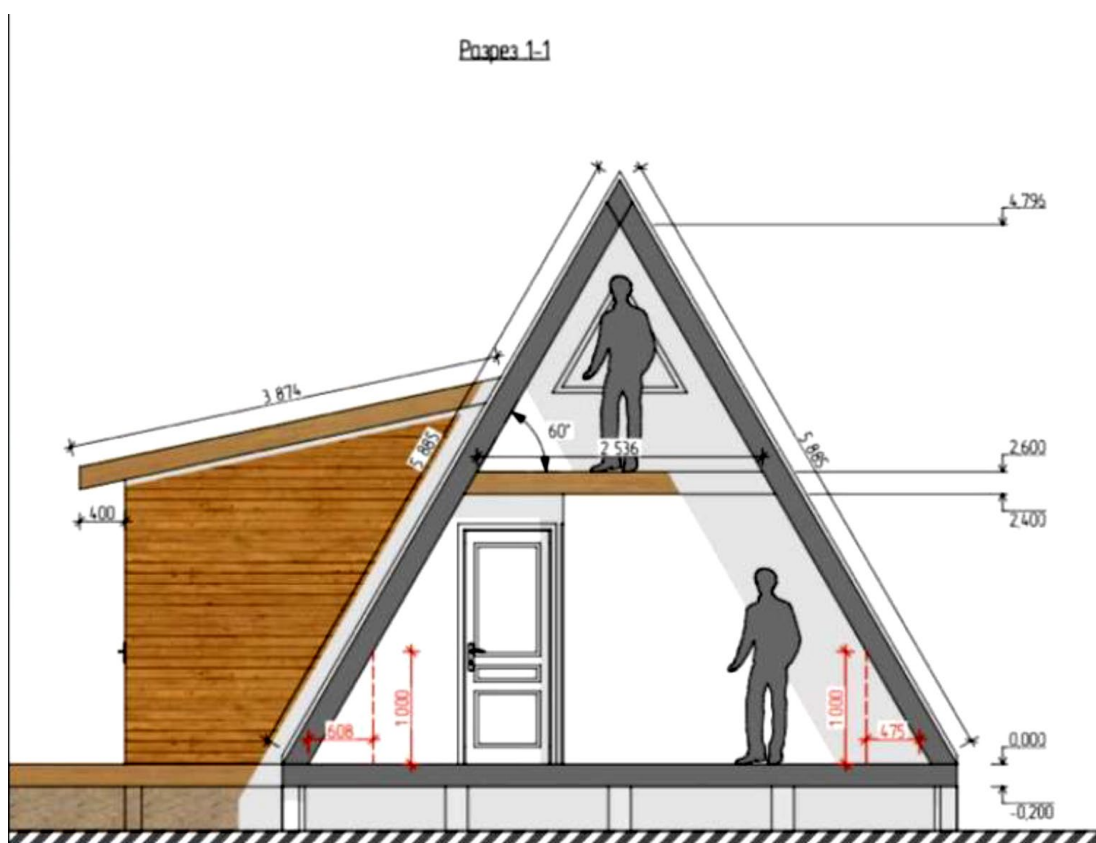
Габаритне креслення планування каркасної будівлі.
